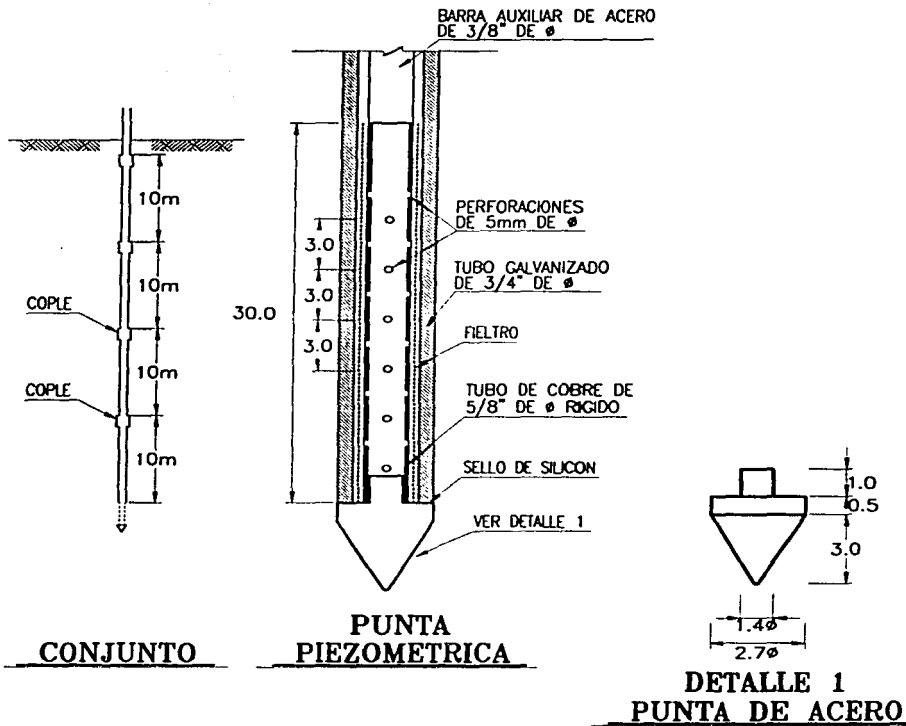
PIEZOMETRO ABIERTO HINCADO.
